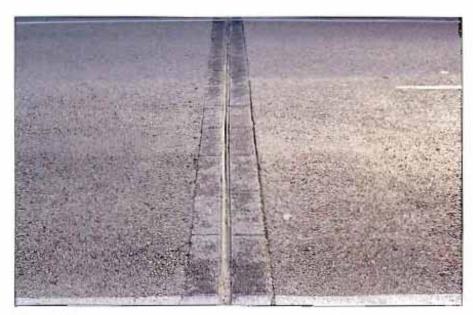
Pavimento de mezcla convencional tunto en el puente como en el resto de la carretera
